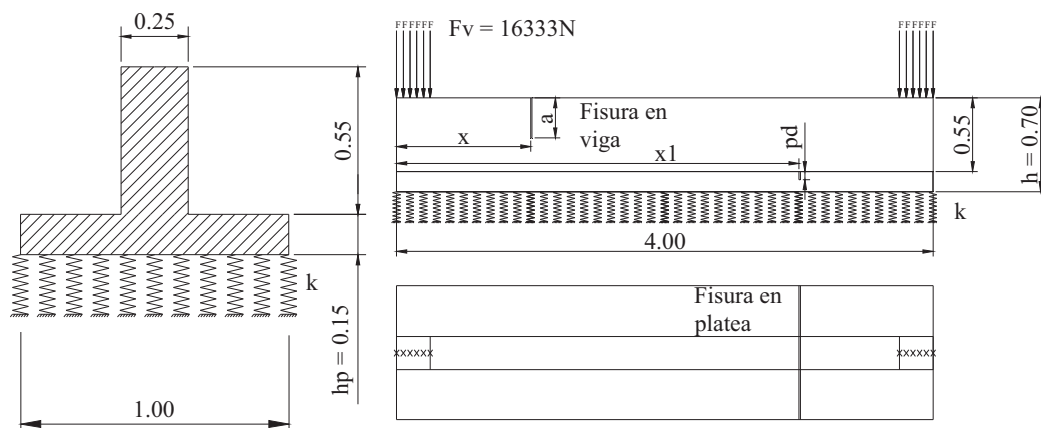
Modelo de Viga de Fundación con fisura en la viga y en la platea (unidades de long. en metros)
